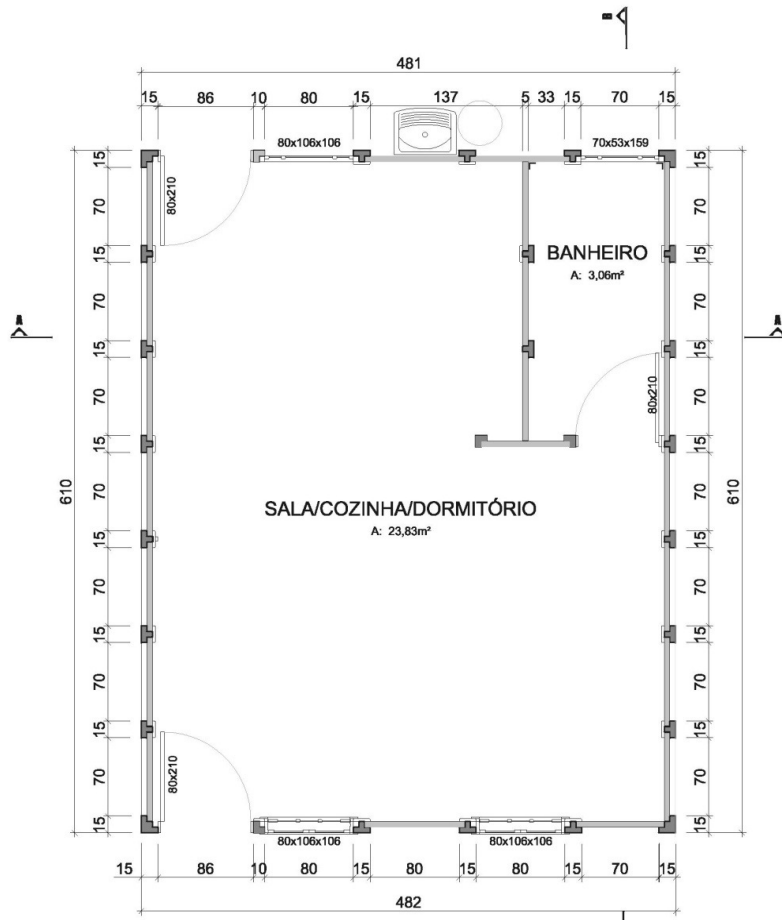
Planta baixa de locação dos pilares do projeto da residência de 29,28m².
